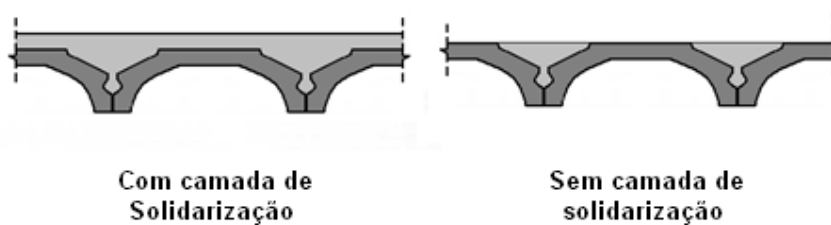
Ligação laje-laje com lajes abobadadas (Stupré, 1981)
